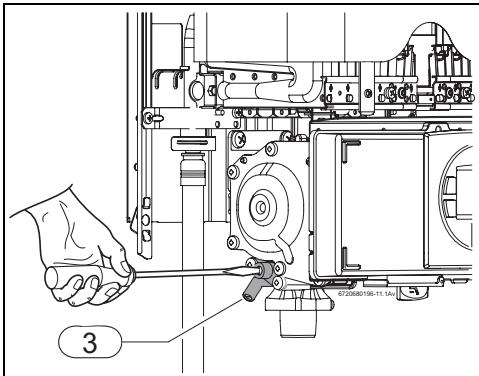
Tornillo de ajuste del caudal máximo de gas
